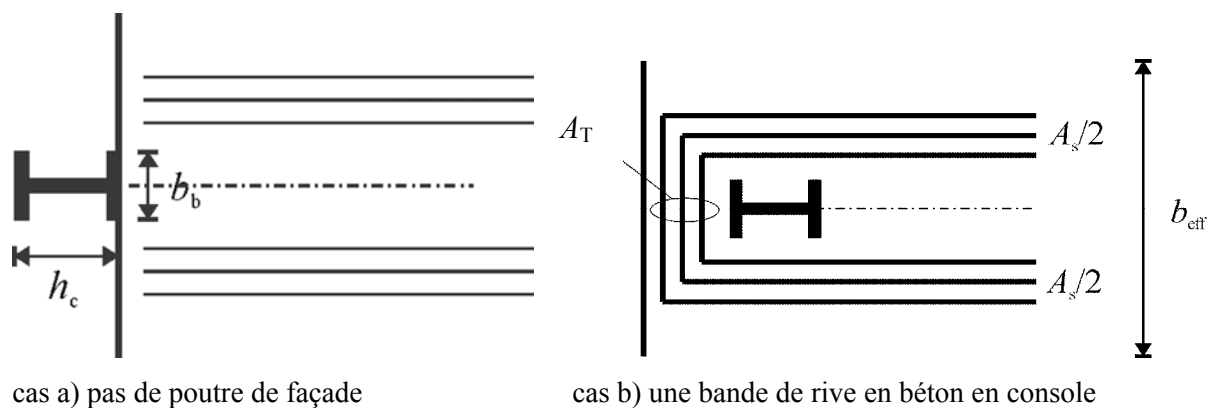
Transfert d'un moment négatif M à un poteau de façade.
